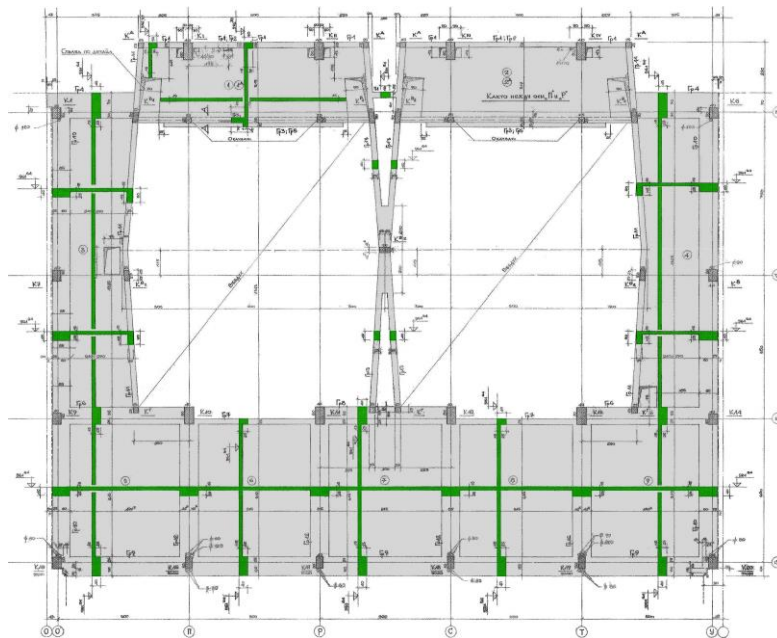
План на фундаментна конструкция – блок 4 на УАСГ
